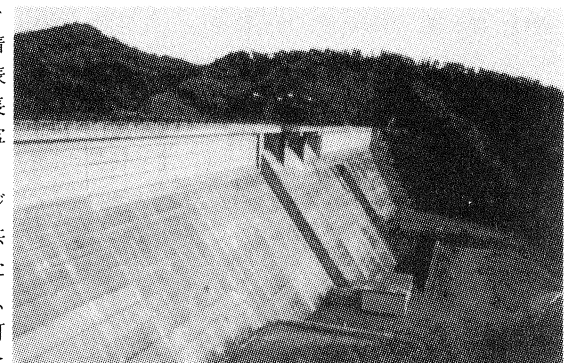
コンクリート素材のエージング。天を仰ぐ面と鉛直面の表面性状の違い。
